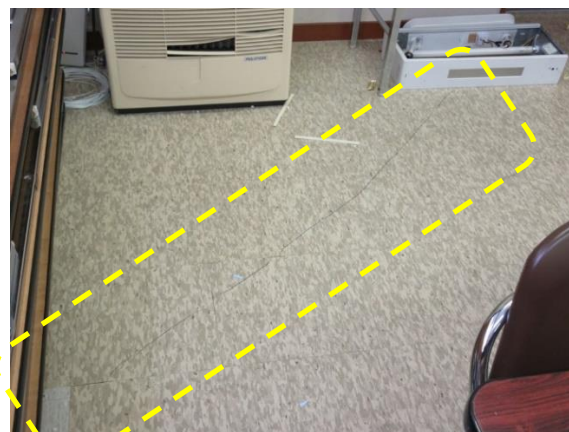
3階講堂床スラブのひび割れ
